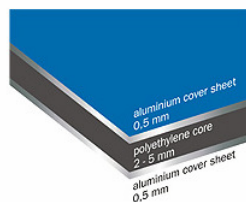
Corte de um painel tricamada de alumínio [20]
